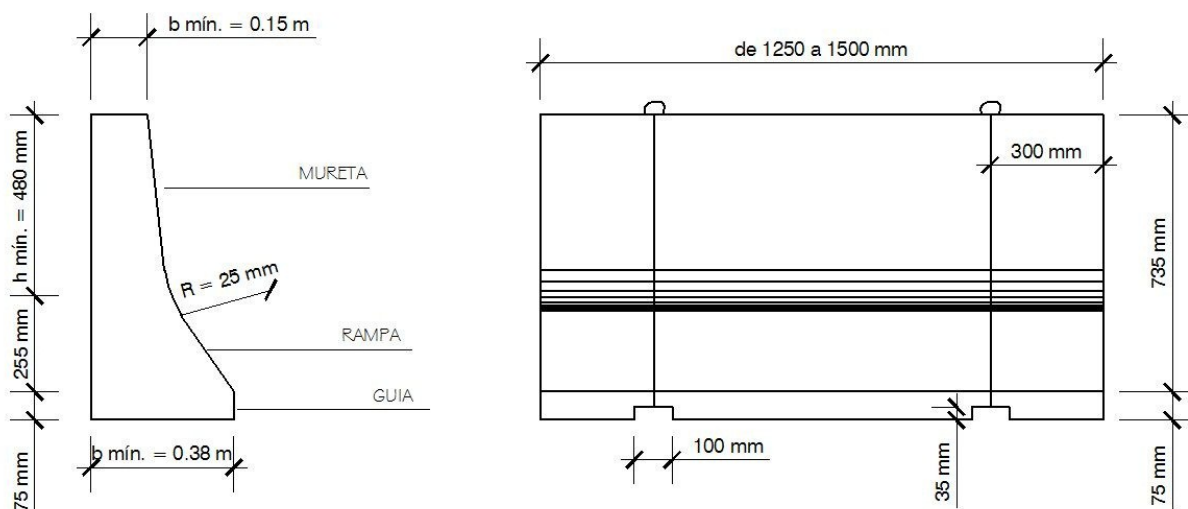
Barreira de Concreto Armado – perfil New Jersey
